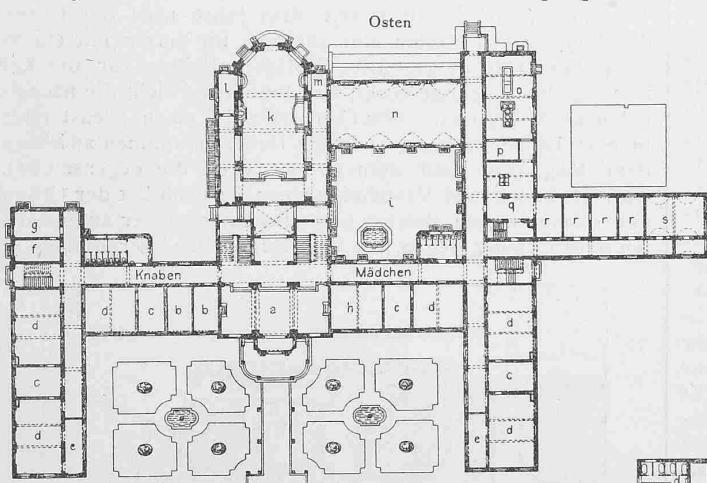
Grundriss vom Erdgeschoß. — Masstab 1:1000.
